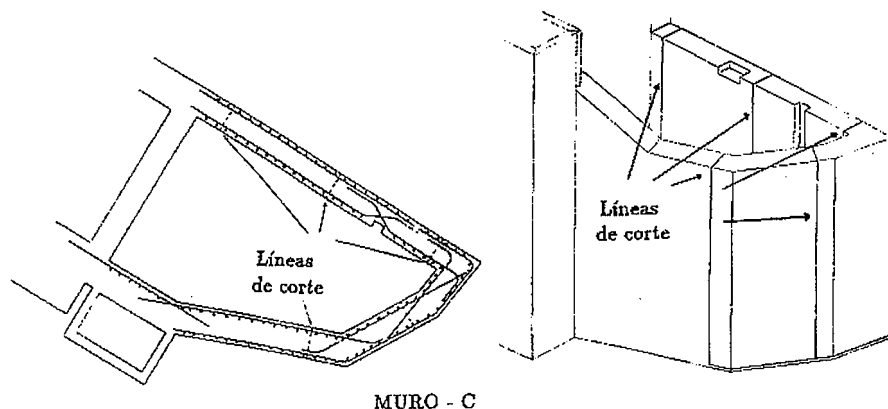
Alzado y planta del muro biológico C. Líneas de corte sobre el mismo.
